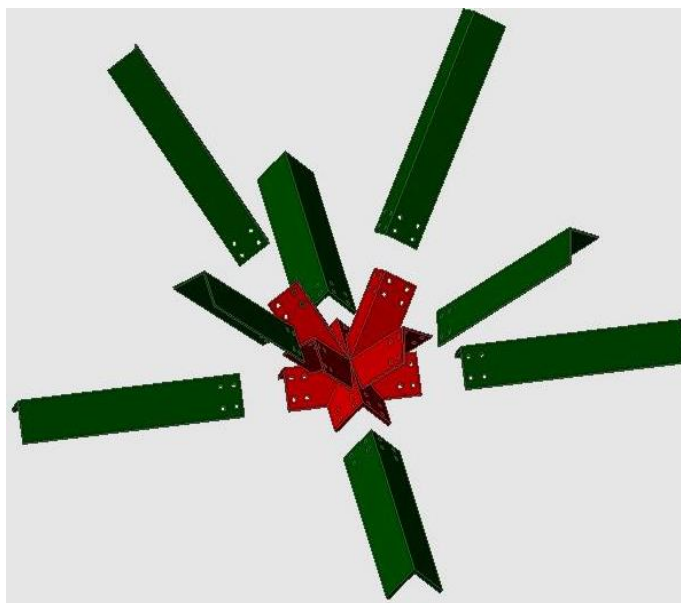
Idéia para ligação do perfil cantoneira.
